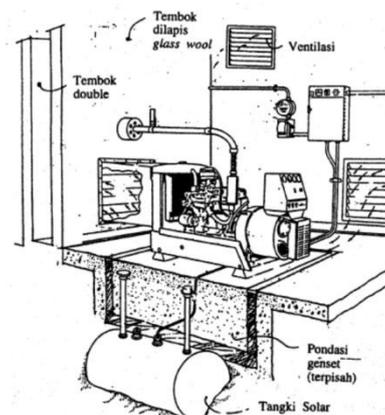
Detail Potongan Ruang Genset
